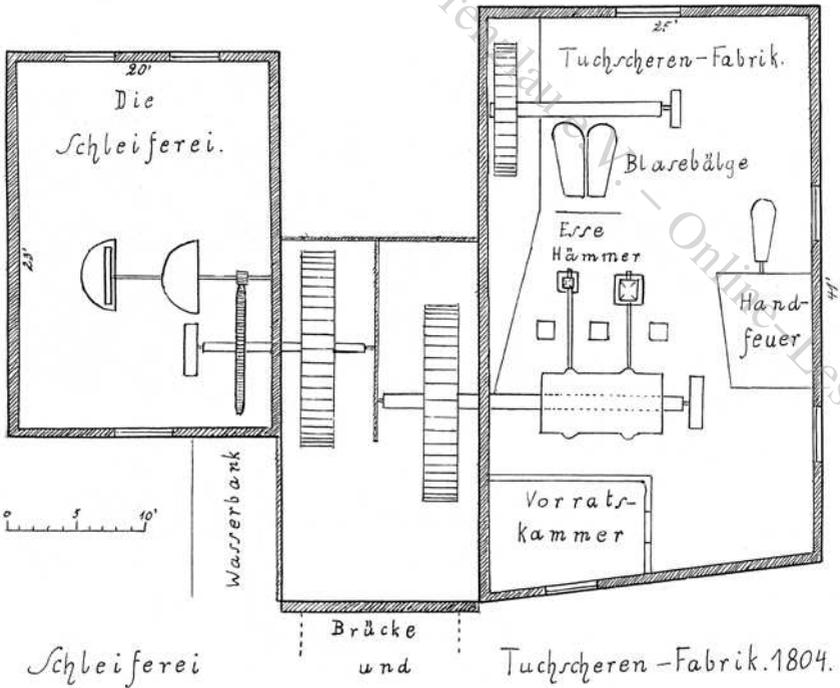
Plan der Tuchscherefabrik (Zeichnung: L. Riewald)
